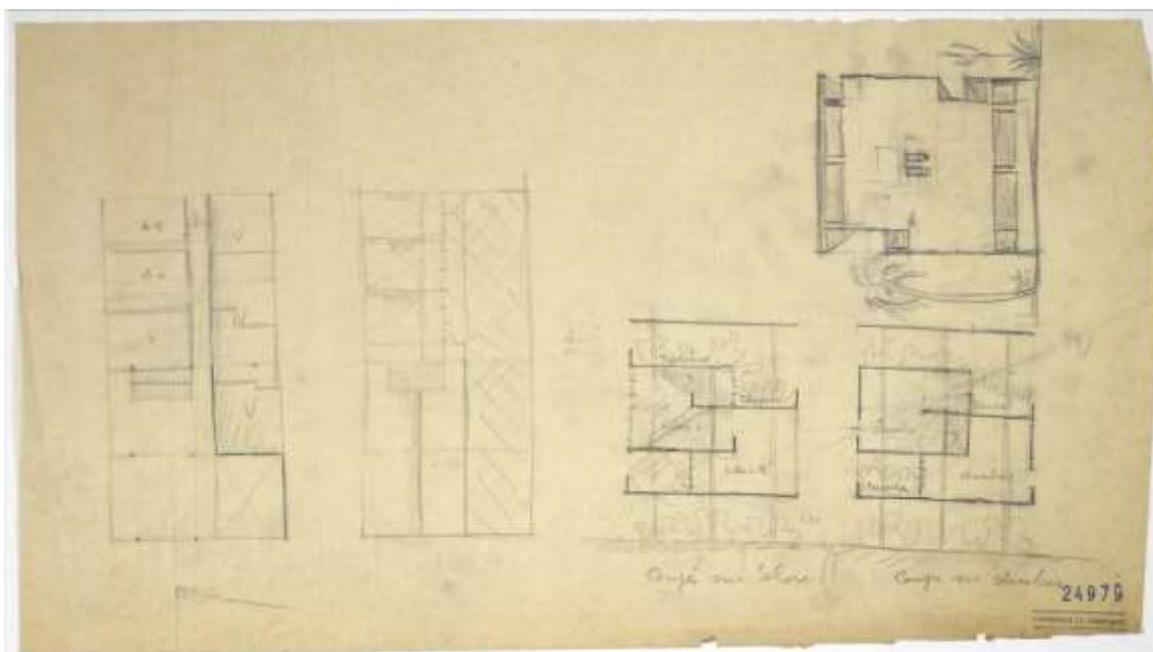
FLC 24979 croquis de coupes, plan et façade avec un tracé représentant la ventilation traversante en diagonale
